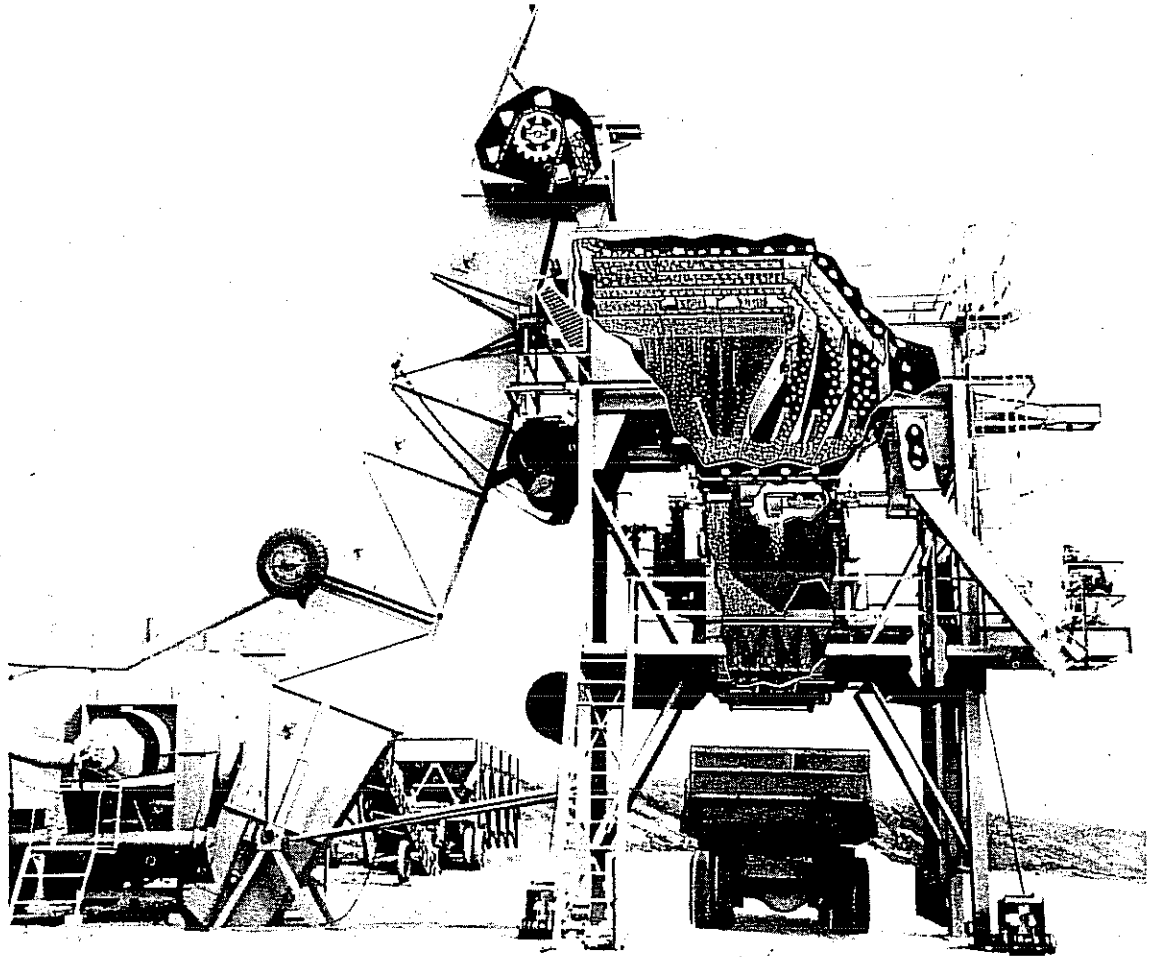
Diagrama en corte de una planta asfáltica de mezclado intermitente
